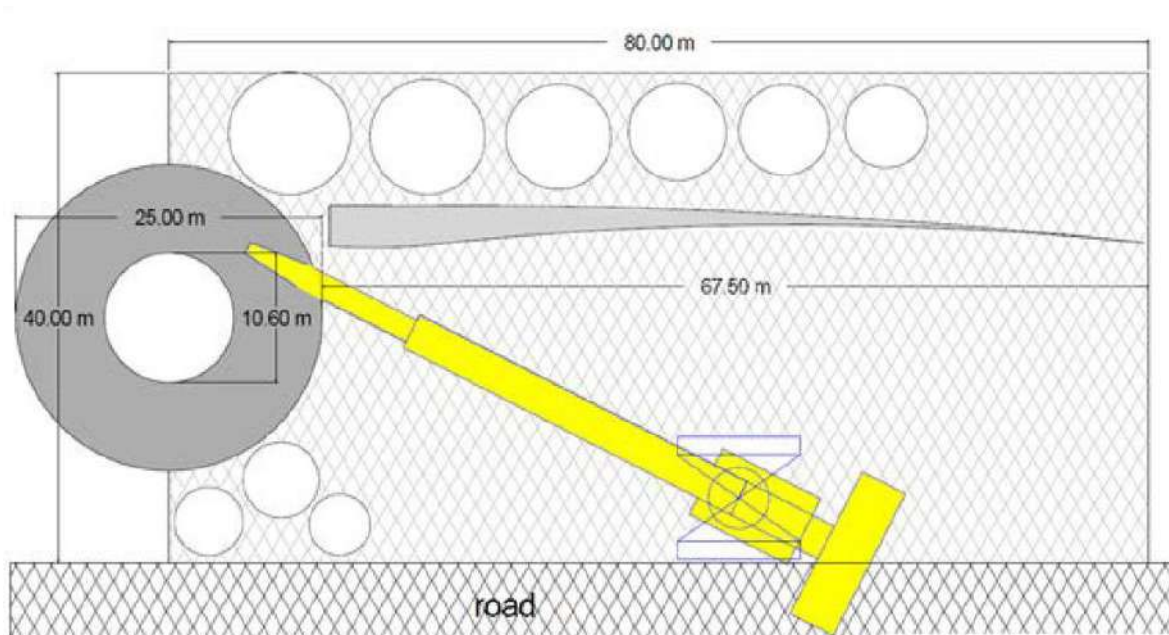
Vista en planta de fundación y locación para grúas y almacenamiento.
